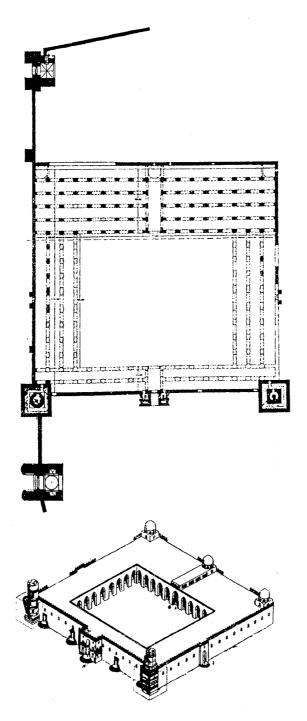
مسقط أفقي للجامع الأزهر في مرحلة إنشائه الاولي بالقاهرة (عن : هوج).
